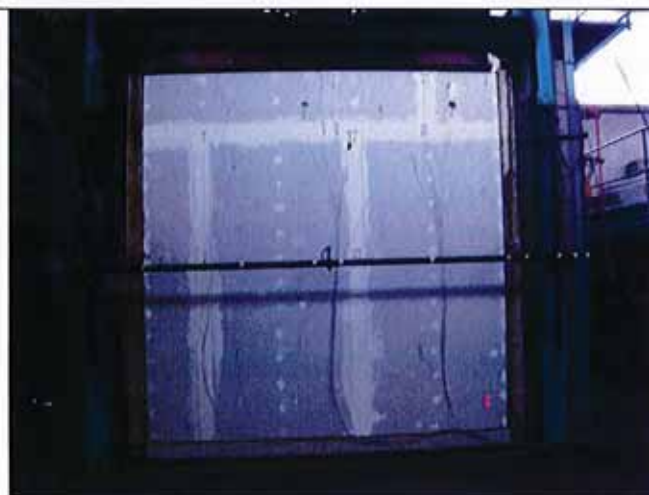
Ansicht der mit Gipskarton-Feuerschutzplatten beplankten Seite.
